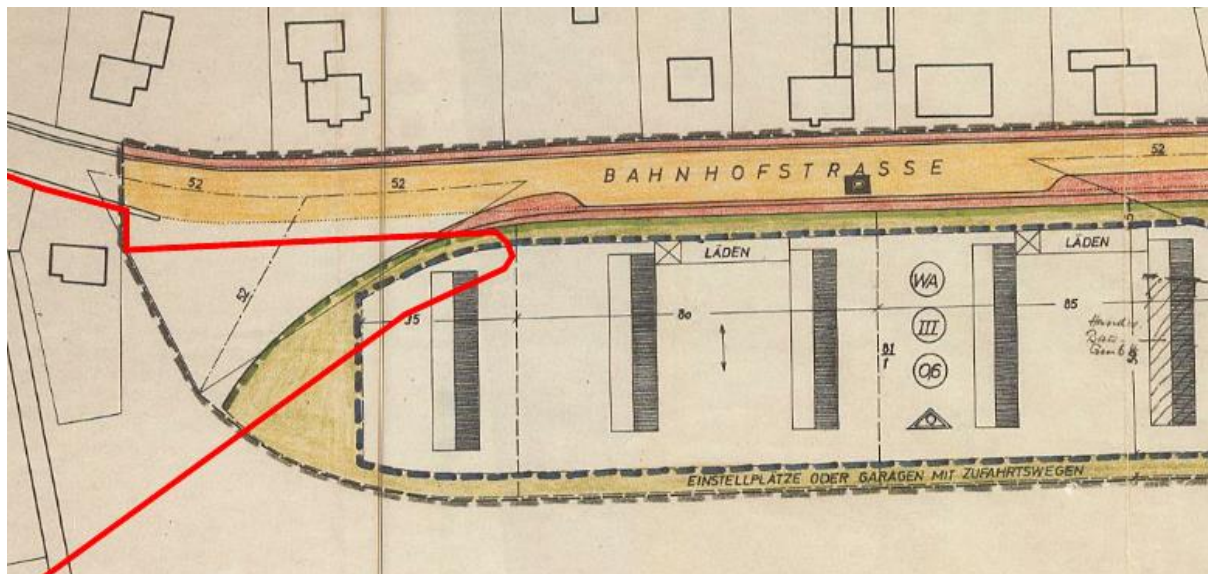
Ausschnitt aus dem B-Plan Nr.5, nicht genordet, Geltungsbereich B-Plan Nr. 56 rot umrandet, ohne Maßstab
